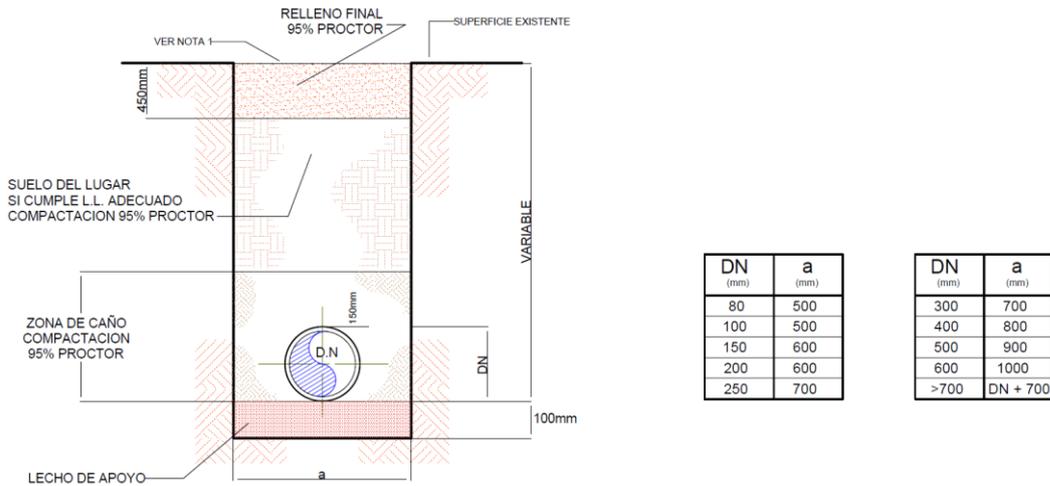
Detalle constructivo de excavaciones para cañerías.
